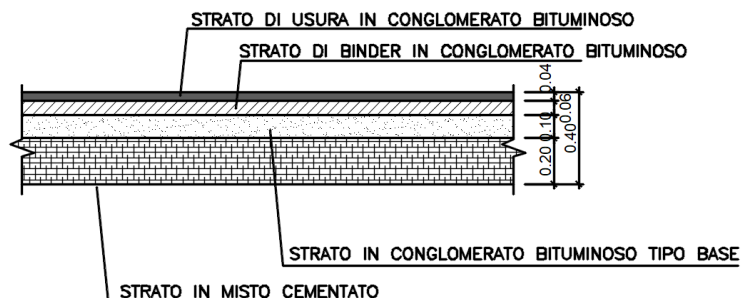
Pacchetto pavimentazione ampliamento piattaforma
